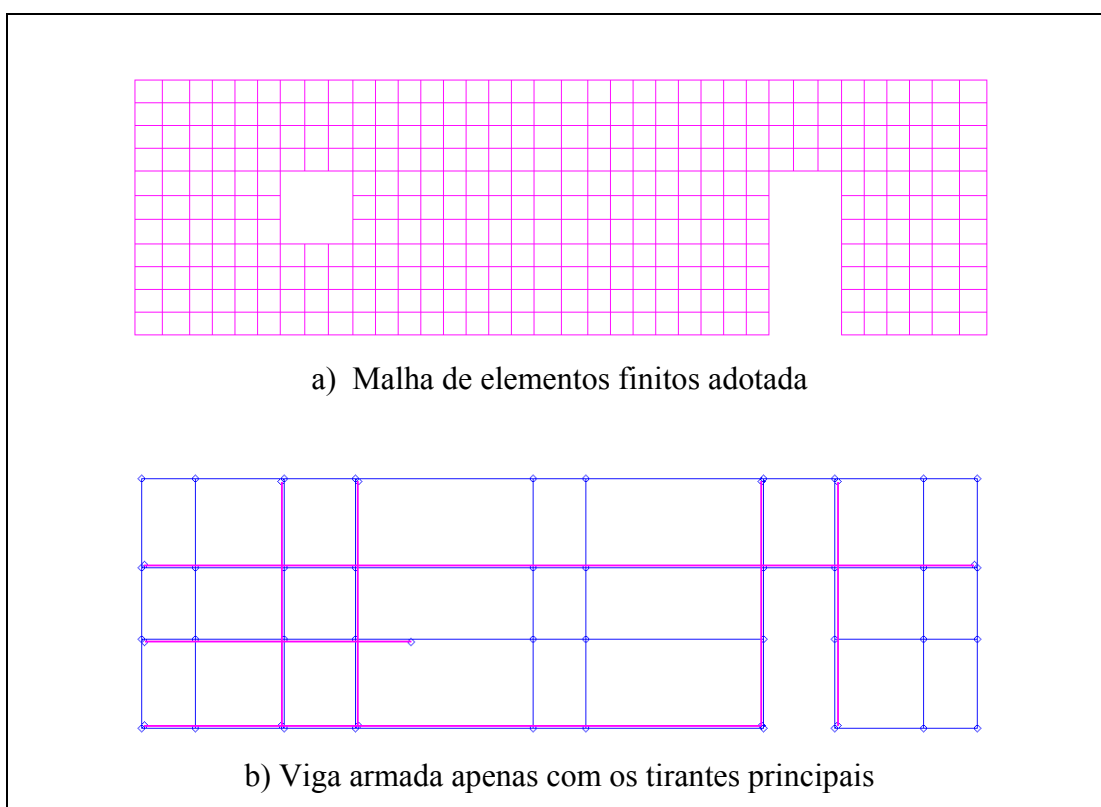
Malha de elementos finitos adotada para viga-parede complexa
